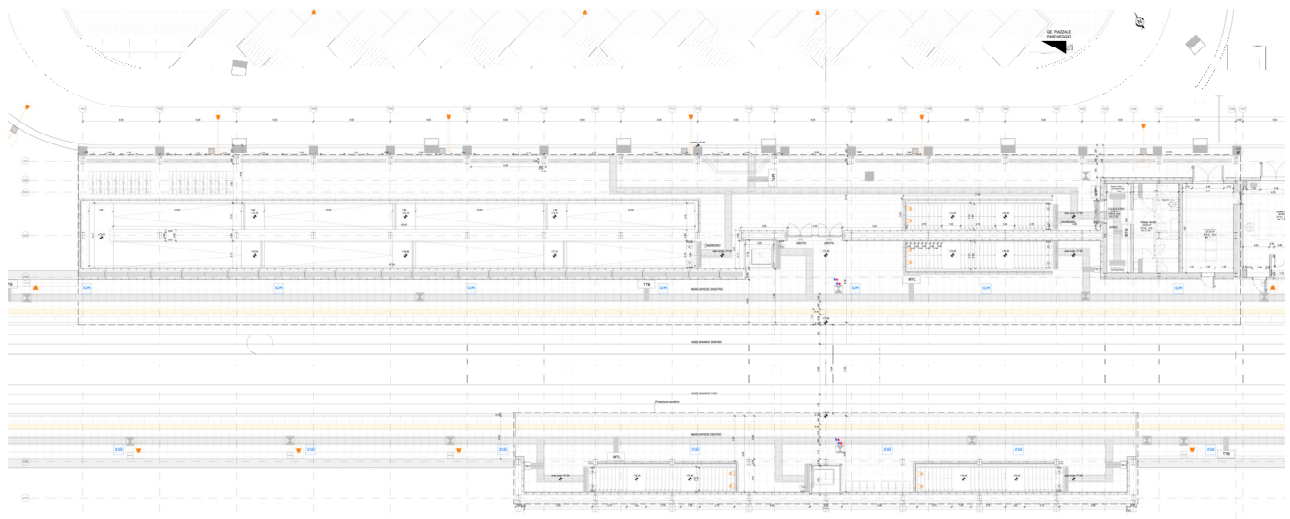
Pianta quota banchine - Fermata San Lorenzo
